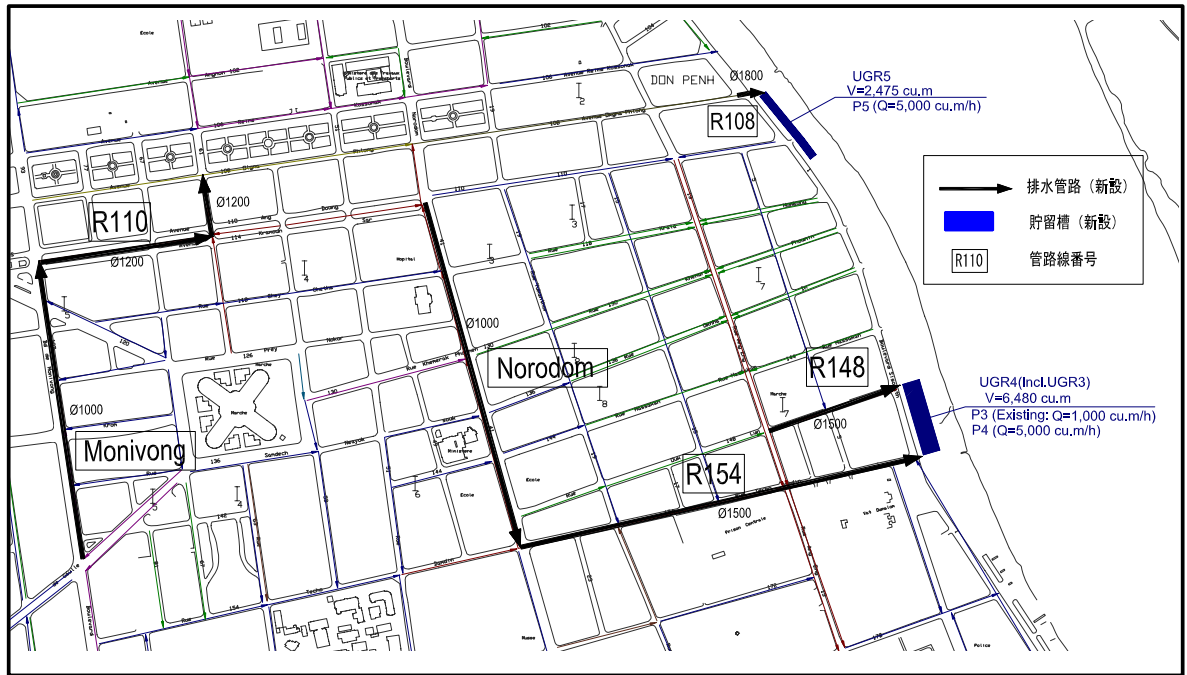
計画排水施設配置図 (中央マーケット排水区)
